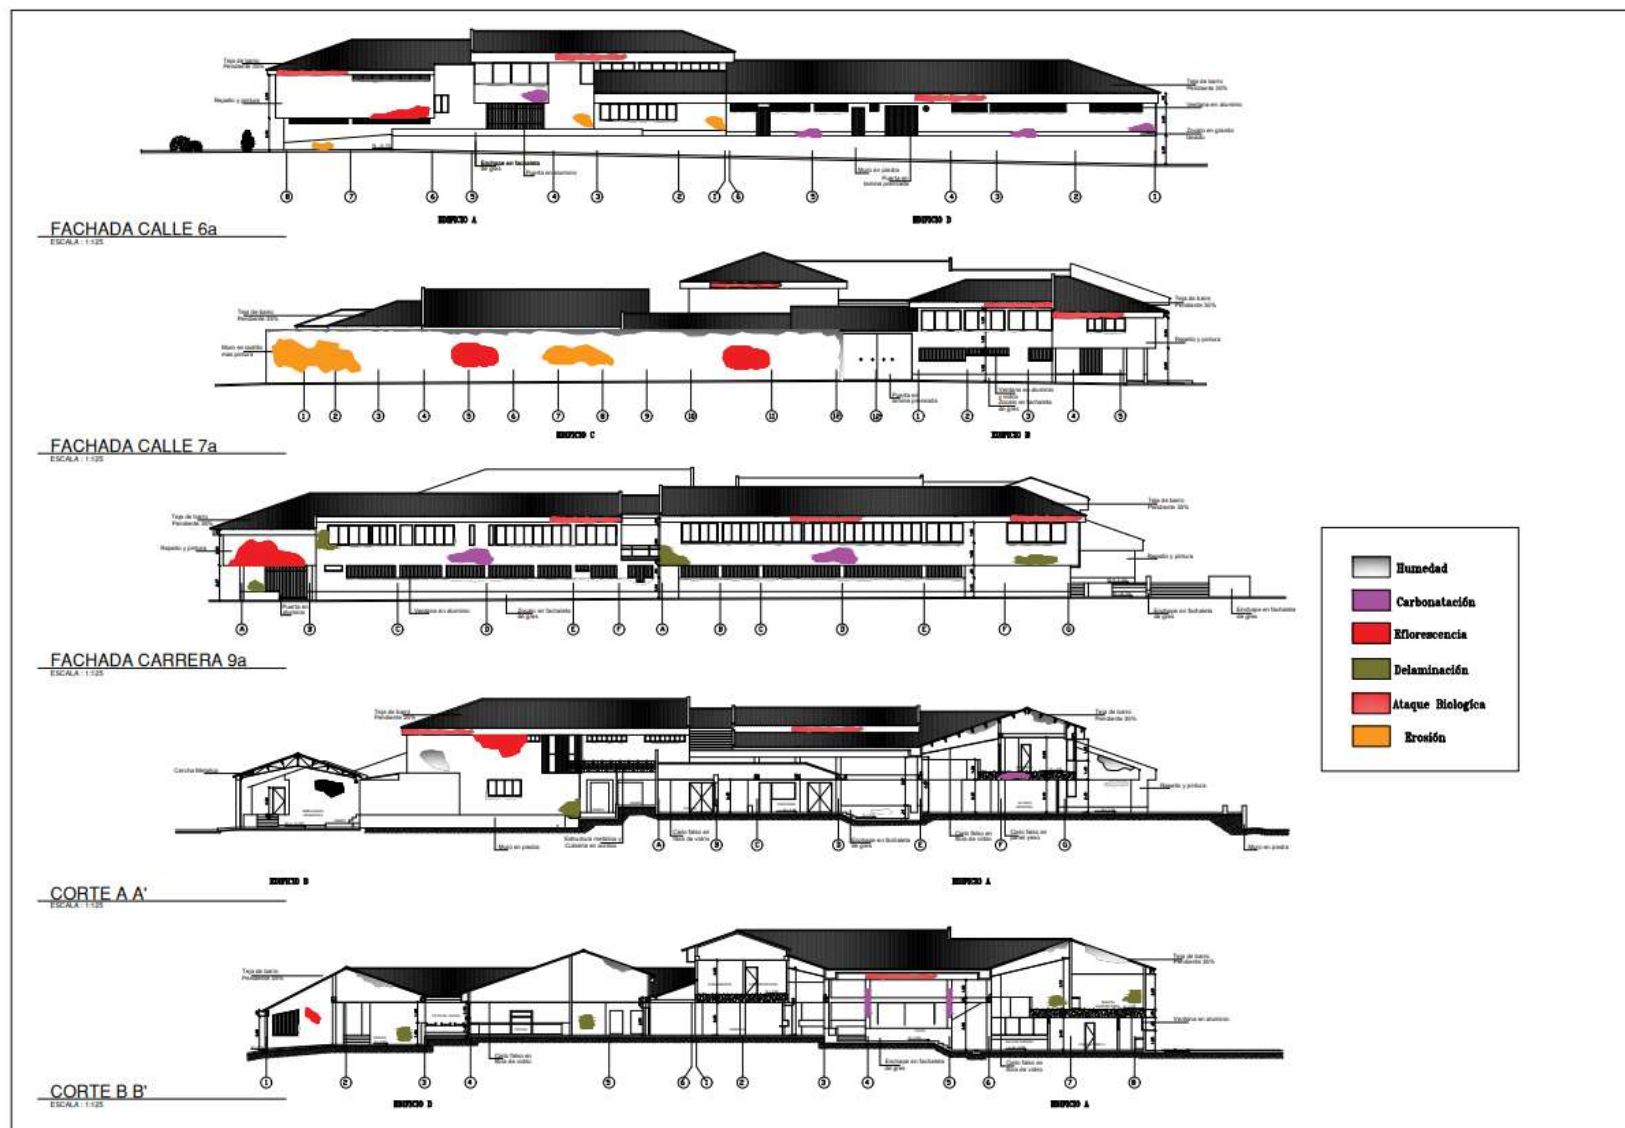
Plano 3 Plano de Calificación Fachadas. Fuente: elaboración propia
